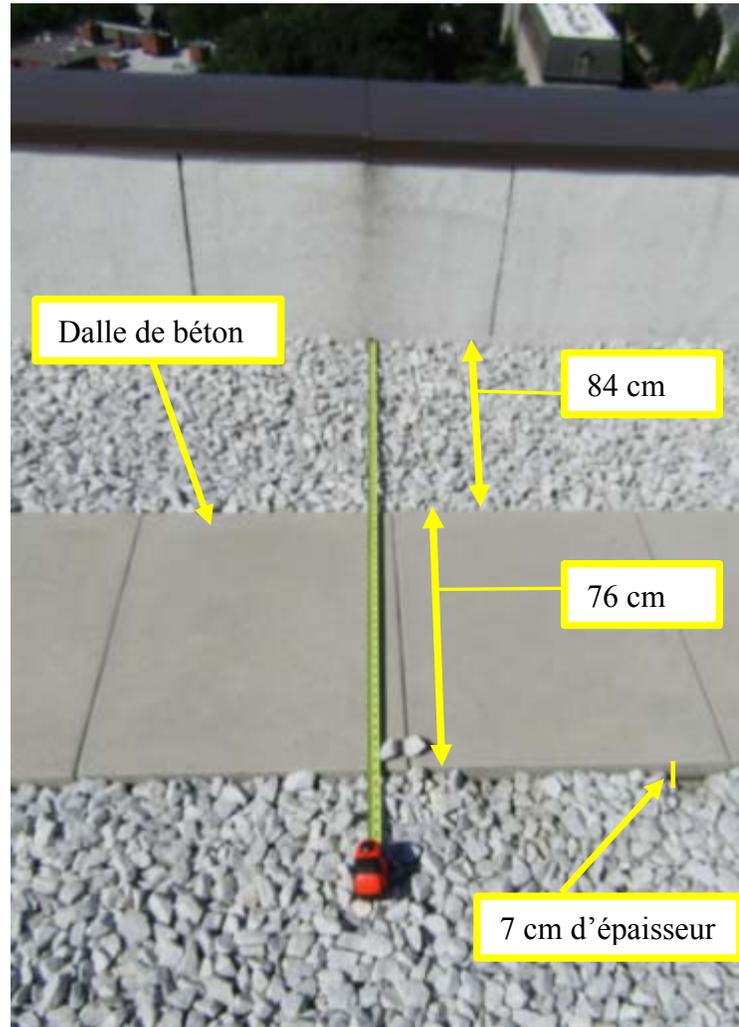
Dalles de béton – vue du toit direction sud-ouest
